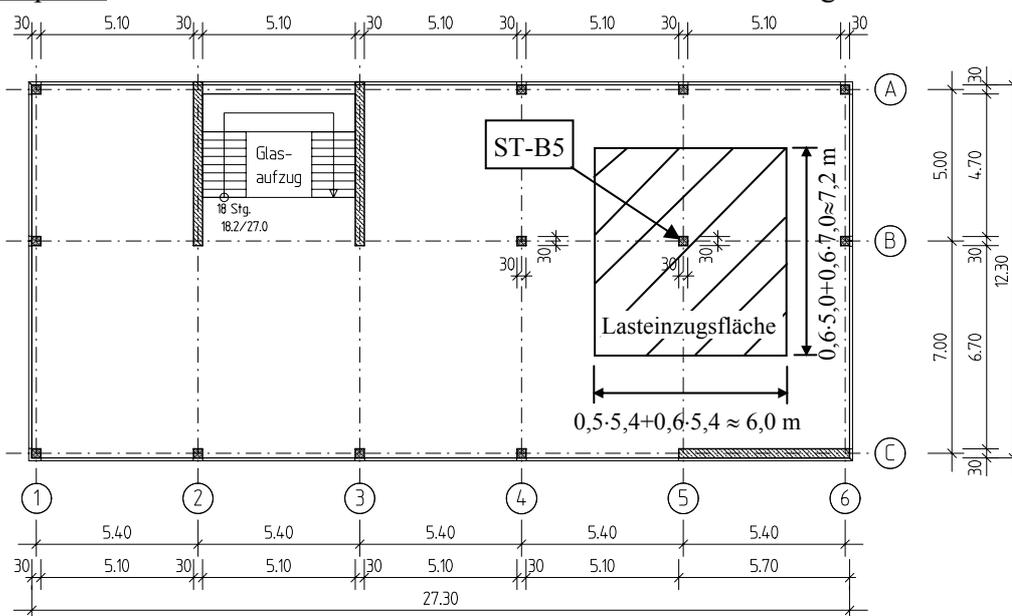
Grundriss einer Flachdecke und Lasteinzugsfläche der Innenstütze ST-B5 [11]
